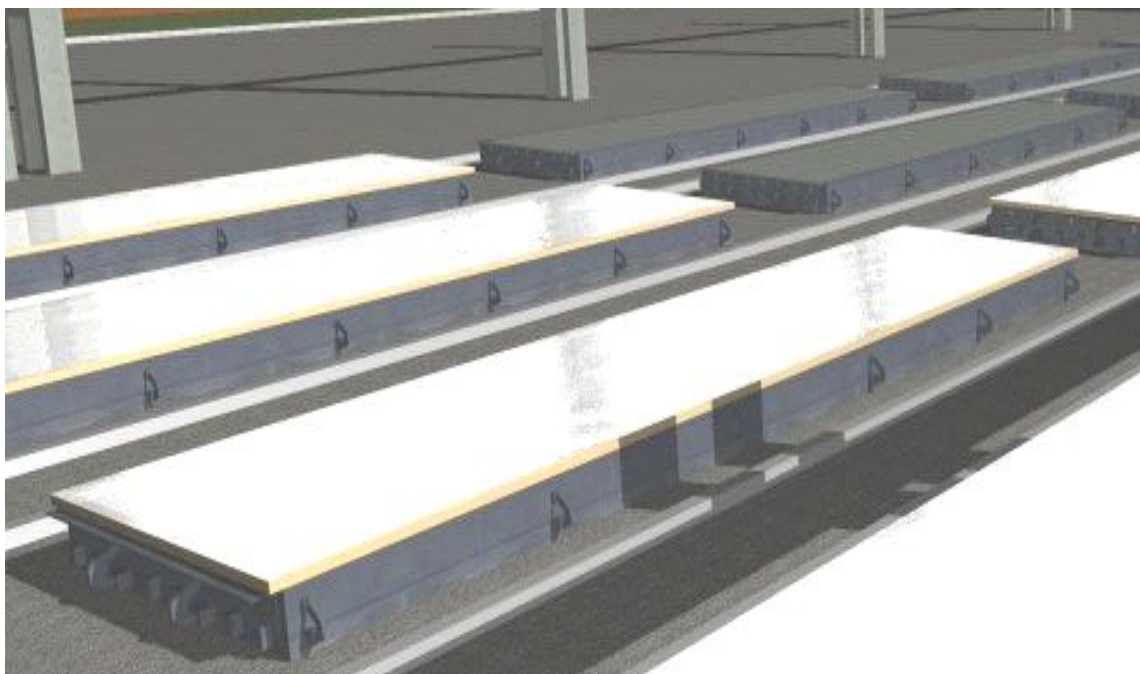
Гелиотермообработка железобетонных изделий из бетонов на комплексных вяжущих с наполнителем из золошлаковых смесей
